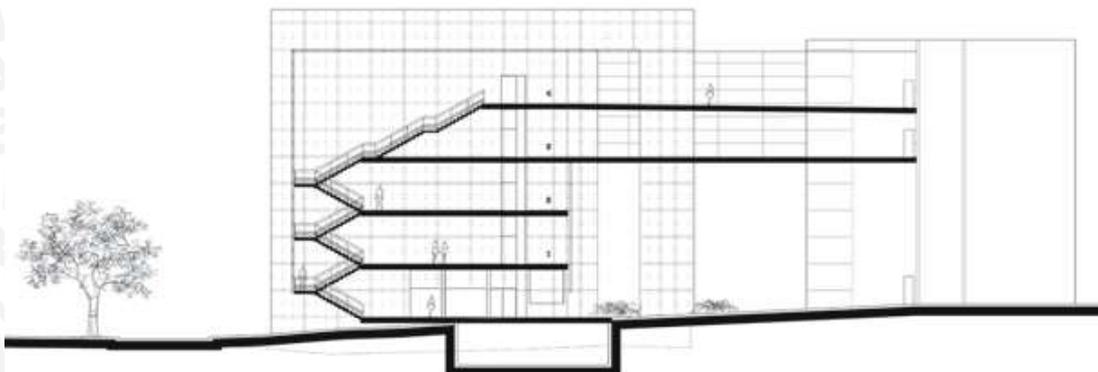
Skema sirkulasi bangunan lama dan bangunan baru
